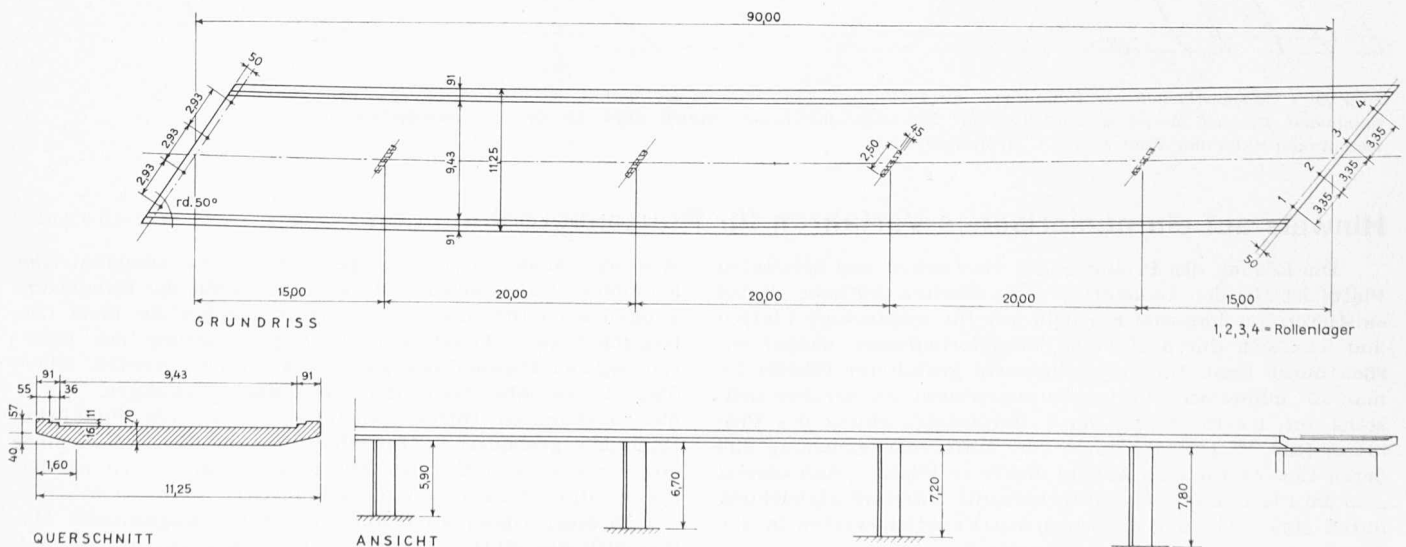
Für den Modellversuch idealisiertes Bauwerk der Ueberführung «Abfahrt Oberland» (S 2) über die Worblaufenstrasse bei Bern. Grundriss und Ansicht 1:600, Querschnitt 1:300
